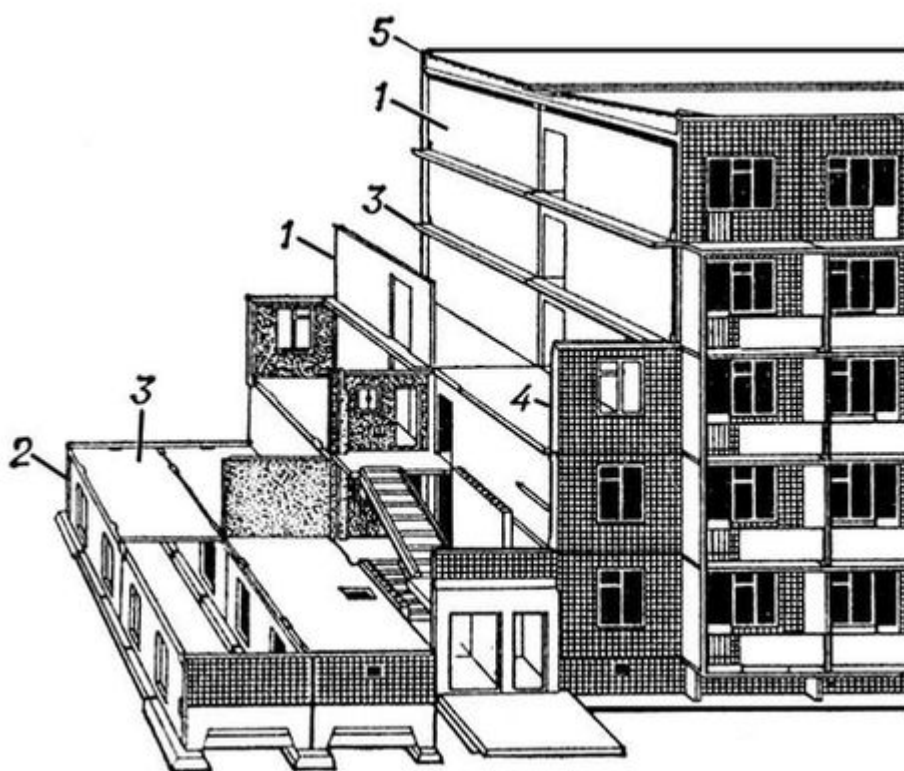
Конструктивная схема крупнопанельного жилого здания:
